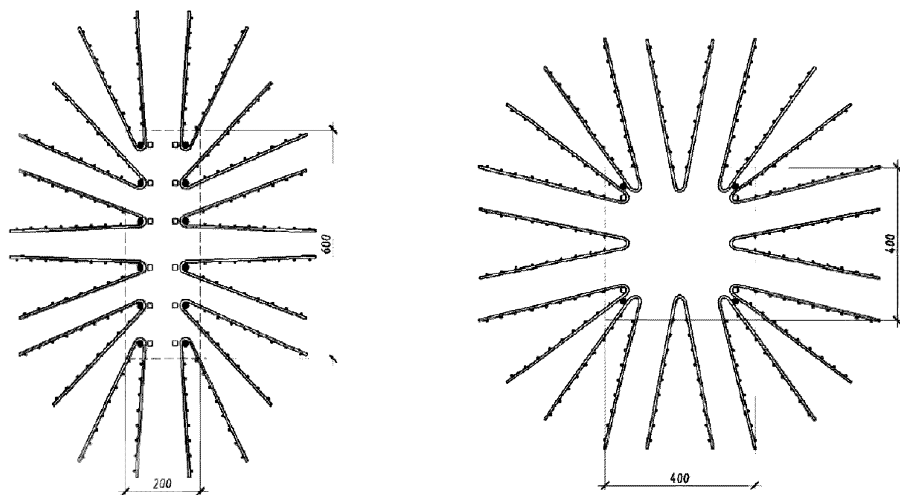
Схемы расстановки каркасов, предотвращающих продавливание плоских плит в зонах опирания на колонны
